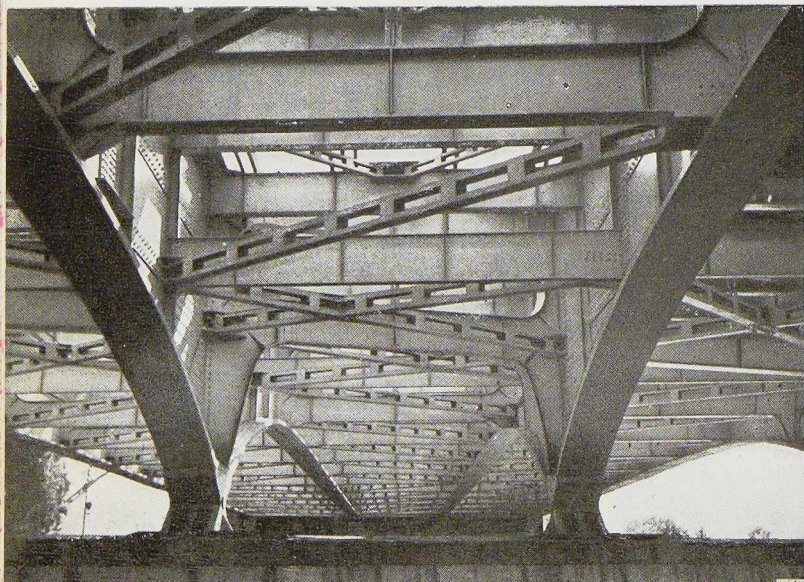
Vue prise en cours de construction montrant notamment les pièces de contreventement et les consoles portant les trottoirs.
